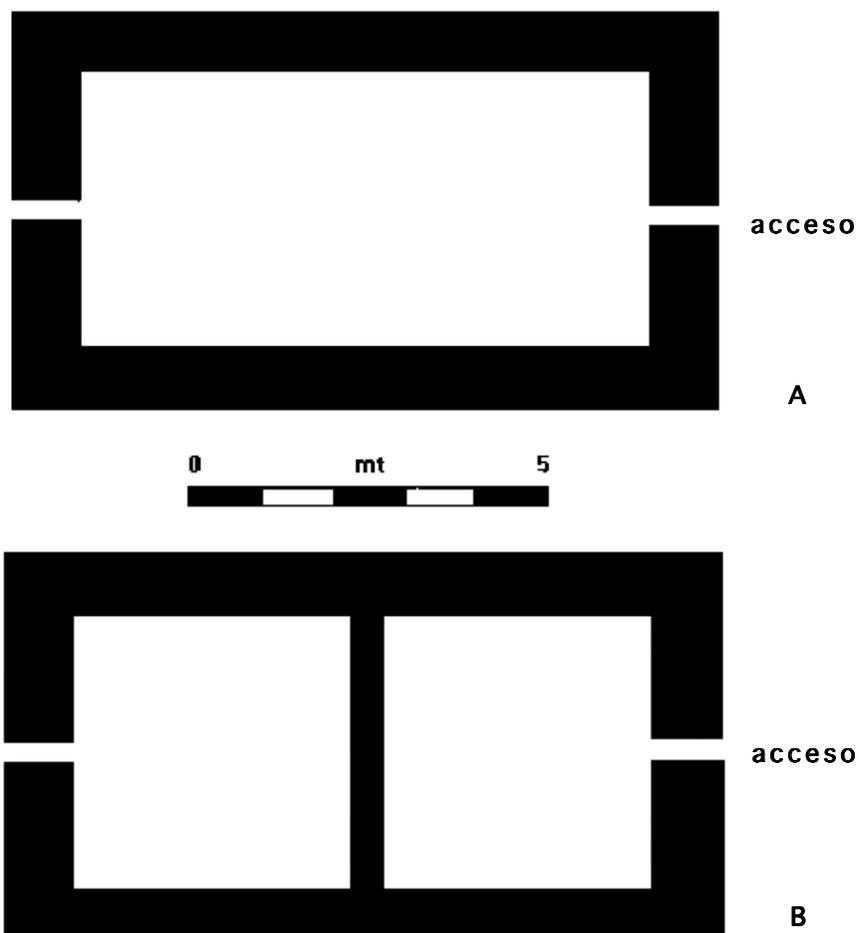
Forma de las estructuras de Tinyaq (A: estructuras sin división; B estructuras con división).
